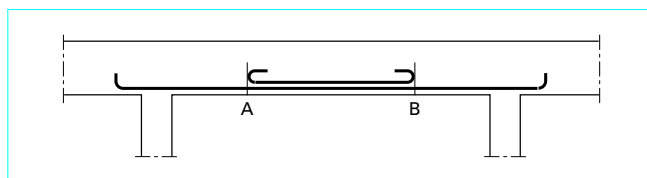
Barres de second lit trop courtes. Risque de fissures en A et B
